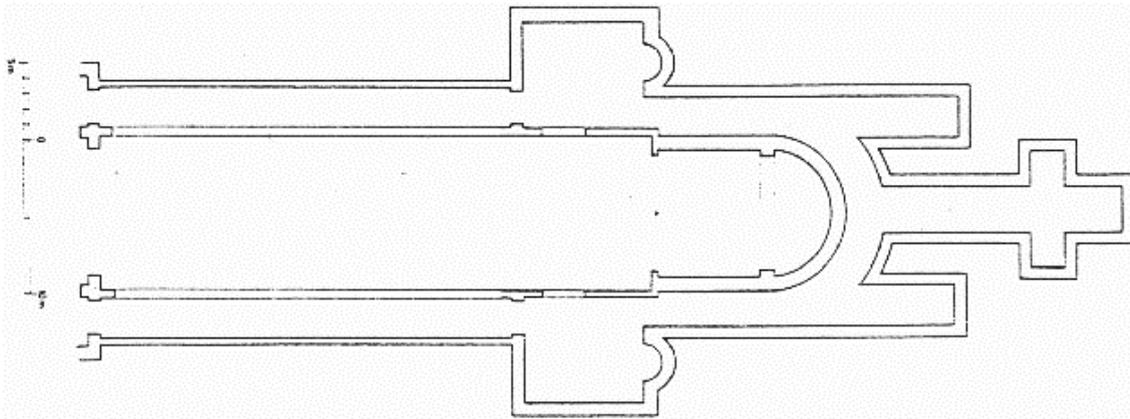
Grundrißrekonstruktion der Gründungsanlage nach Rave.
